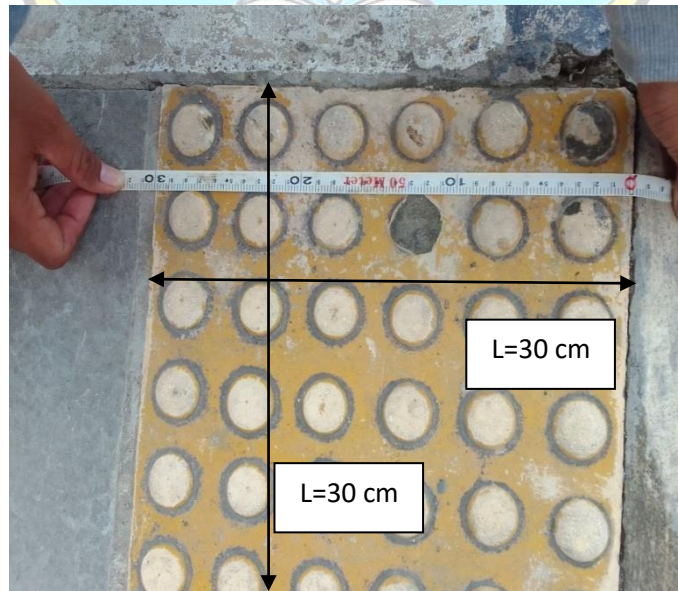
Eksisting Trotoar dilapangan
